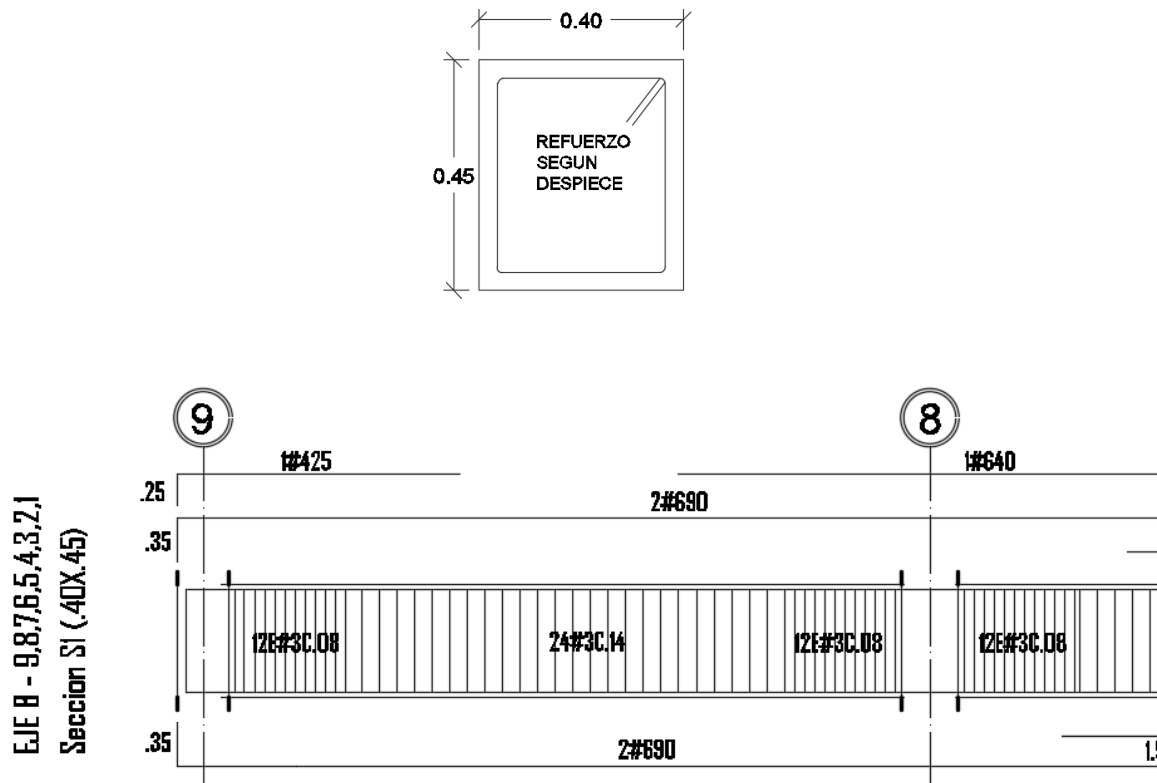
Ejemplo de despiece de viga tipo S1.
